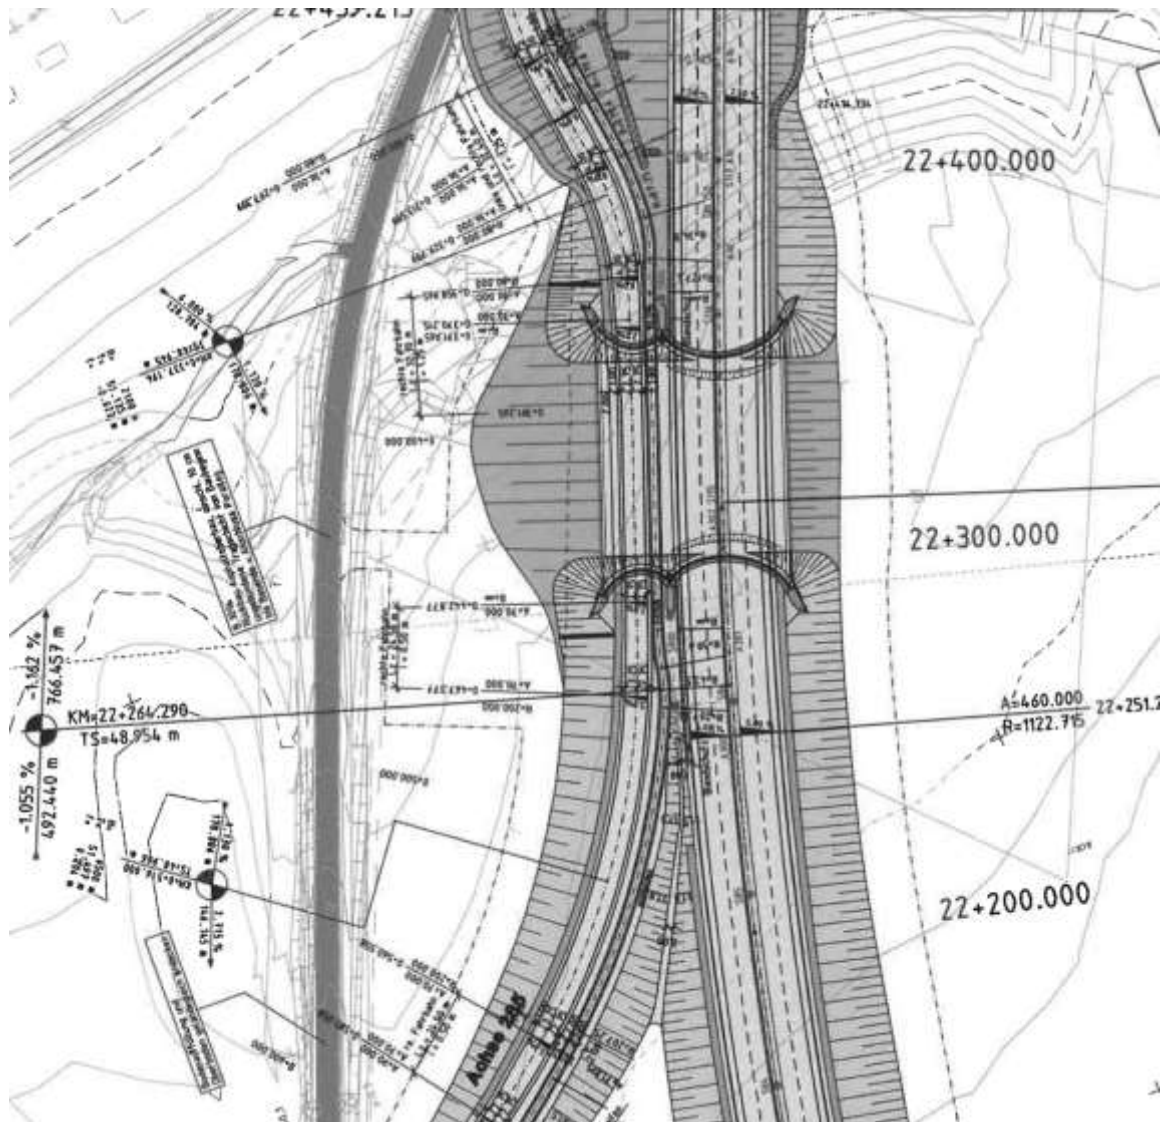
Kartenausschnitt zur Streckenführung (Auszug aus dem Lageplan 7-5 zur Ausschreibung)
